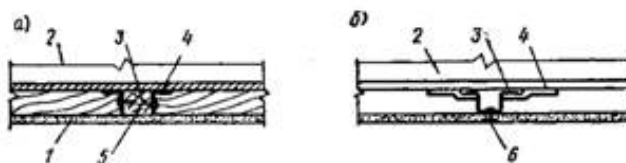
Конструктивные решения облицовки потолков при перекрытиях из металлических балок и плит заполнения
